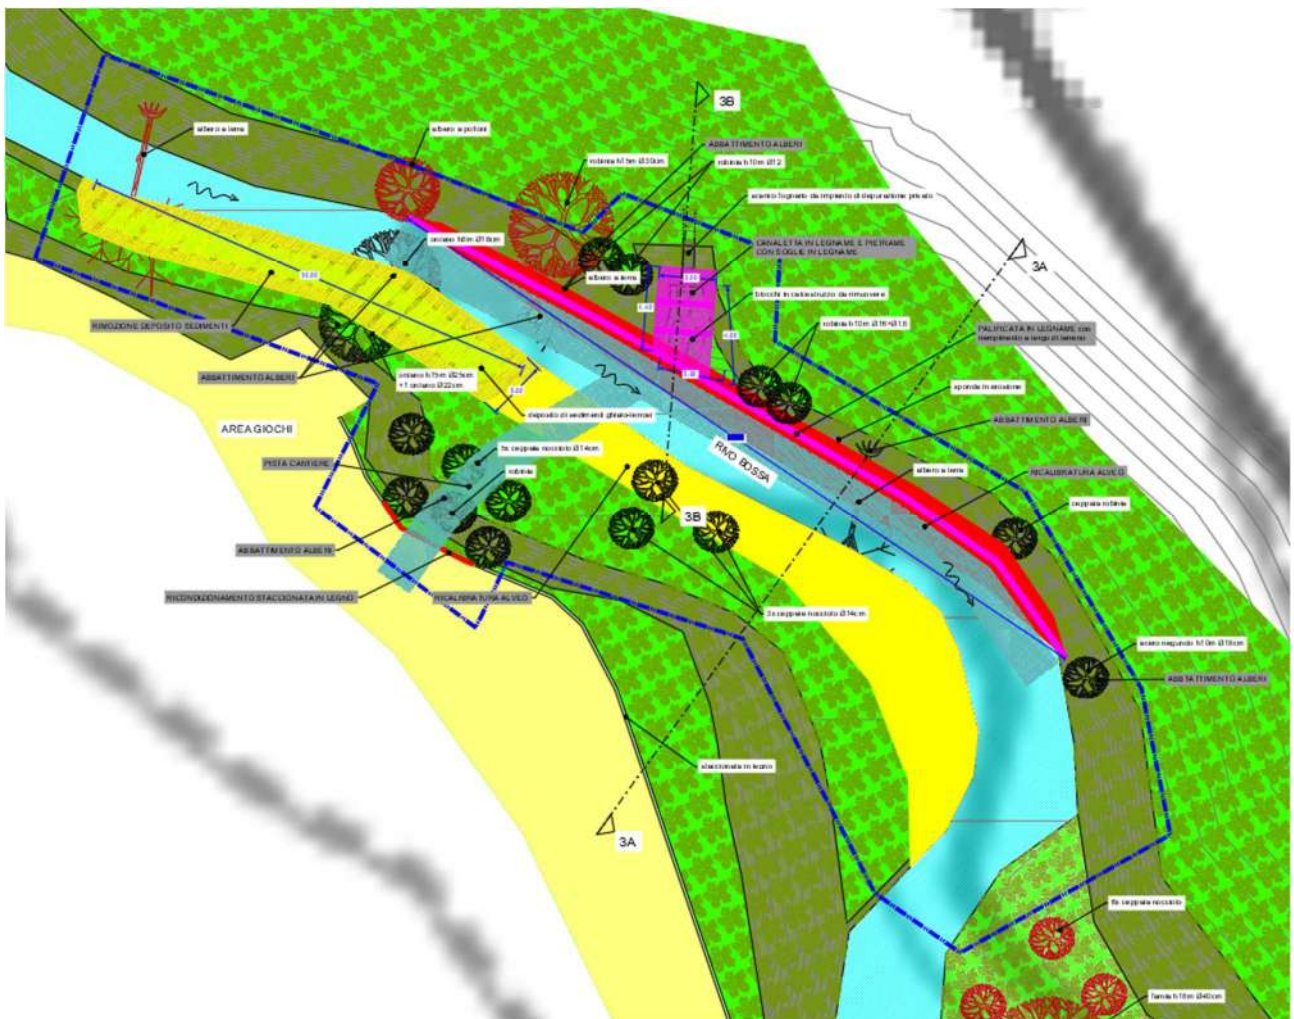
Planimetria di progetto. (rappresentazione non in scala)
